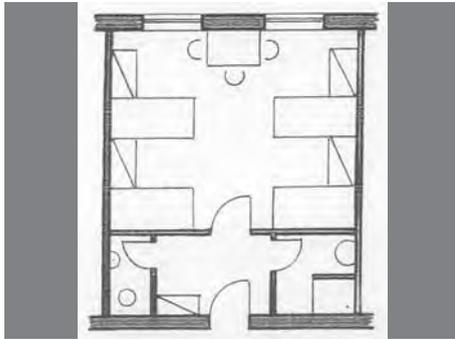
Grundrissdarstellung - Unterkunftsmodul A
